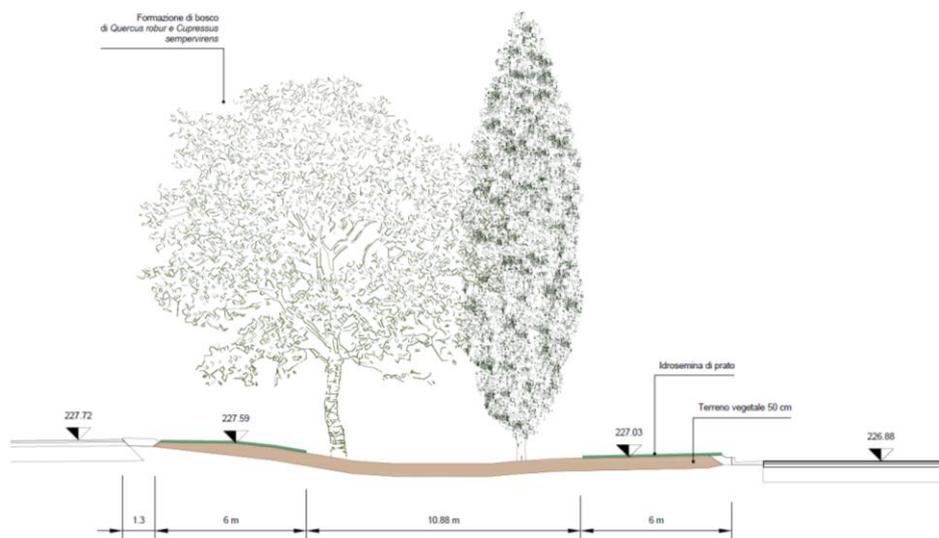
Sezioni e dettagli interventi opere a verde
